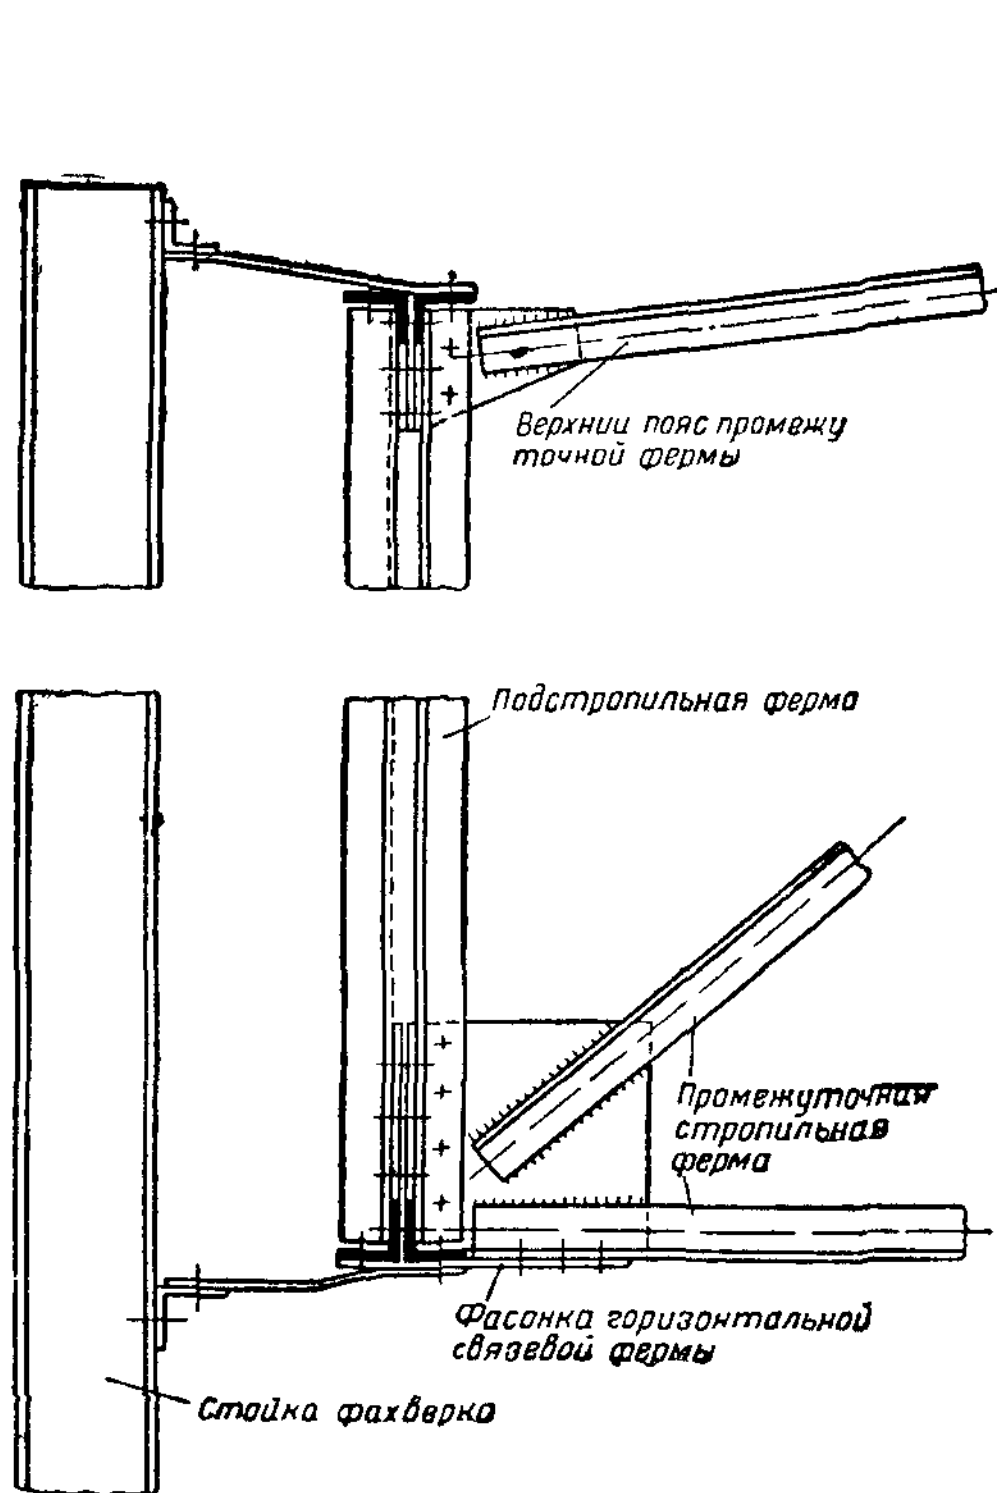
Прикрепление стойки фахверка к узлам подстропильной фермы
